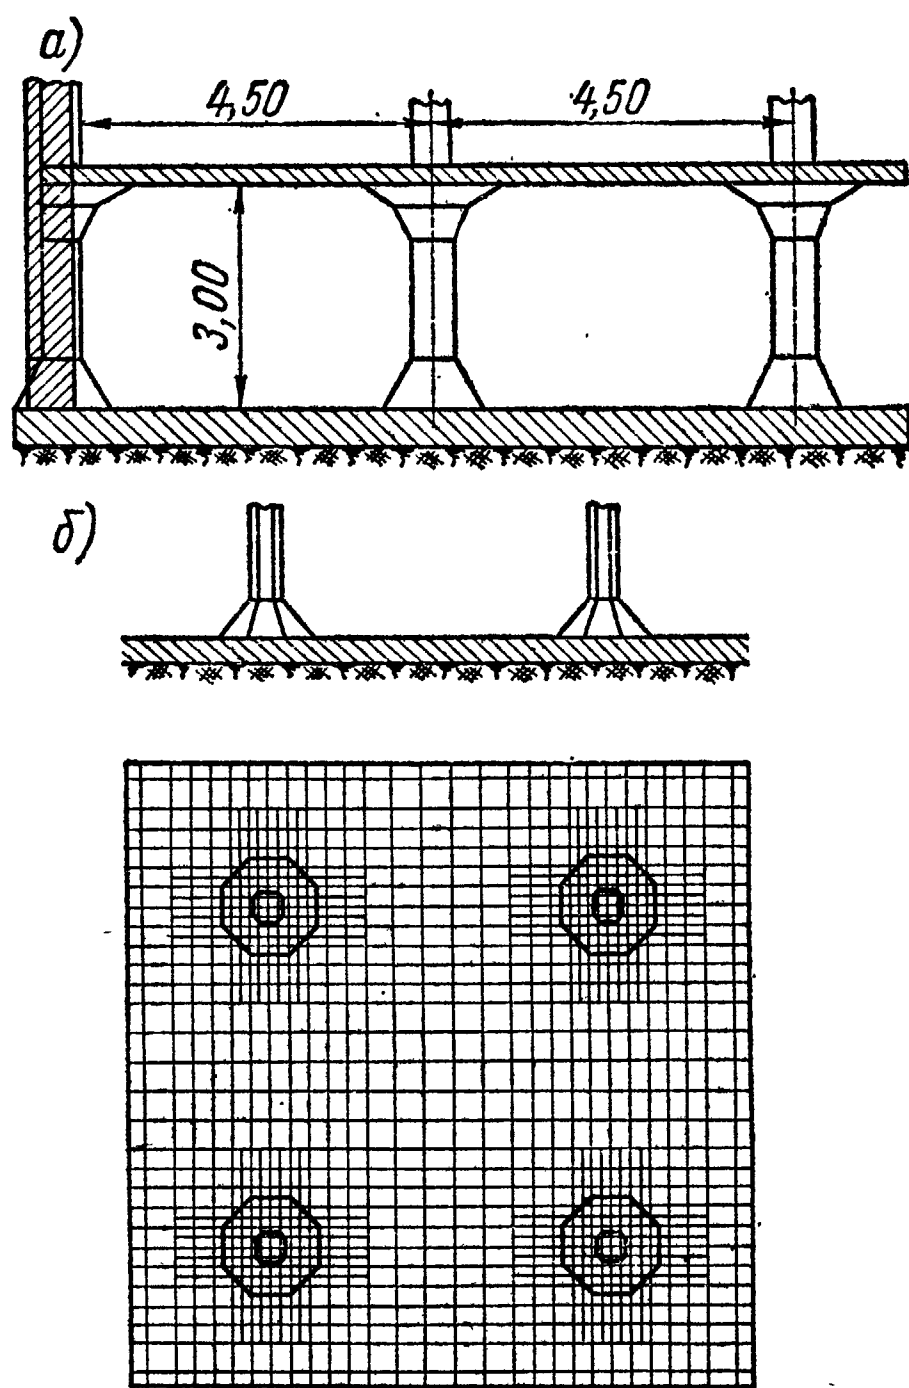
Сплошной фундамент в виде обратного безбалочного (грибовидного) перекрытия и его армирование
